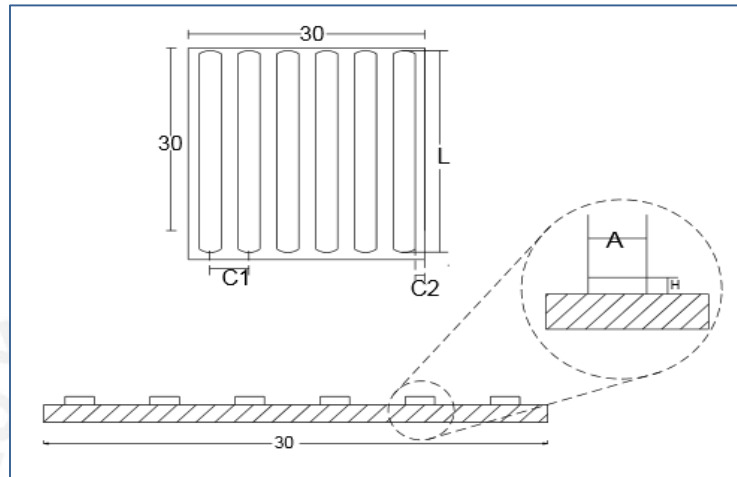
Pavimento guía. Fuente: SEDUVI, 2012.
